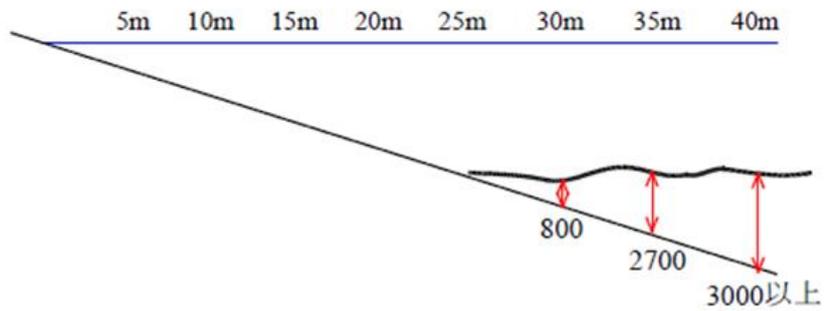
鳥毛 No.4 レール堆積状況 (mm)
